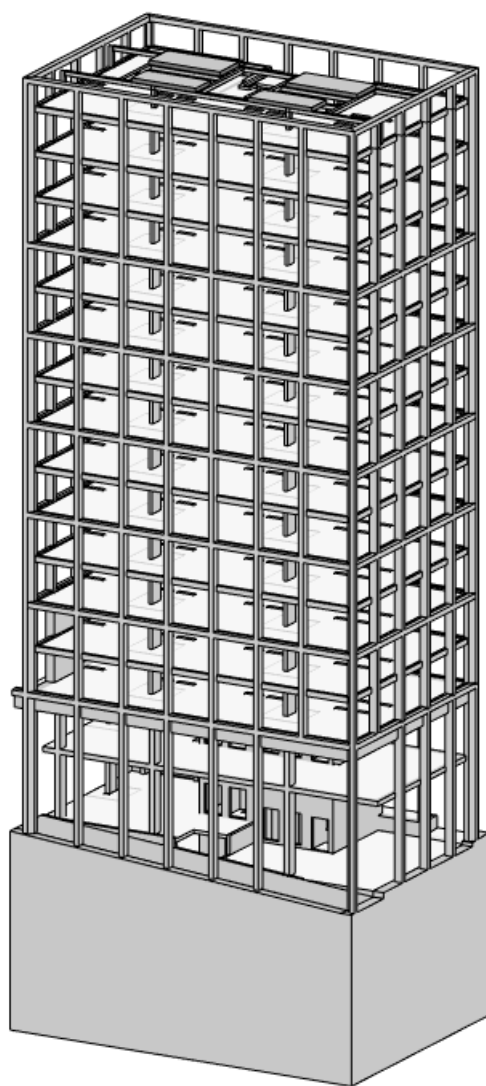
Modelo 3D Da Estrutura (Revit)
